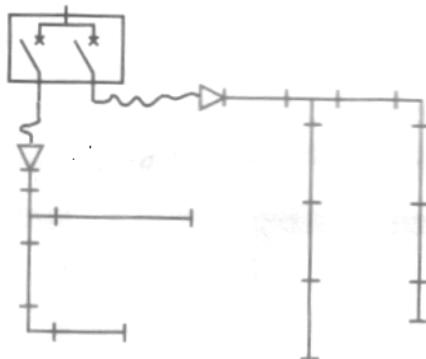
Schéma d'installation en canalisations préfabriquées.
